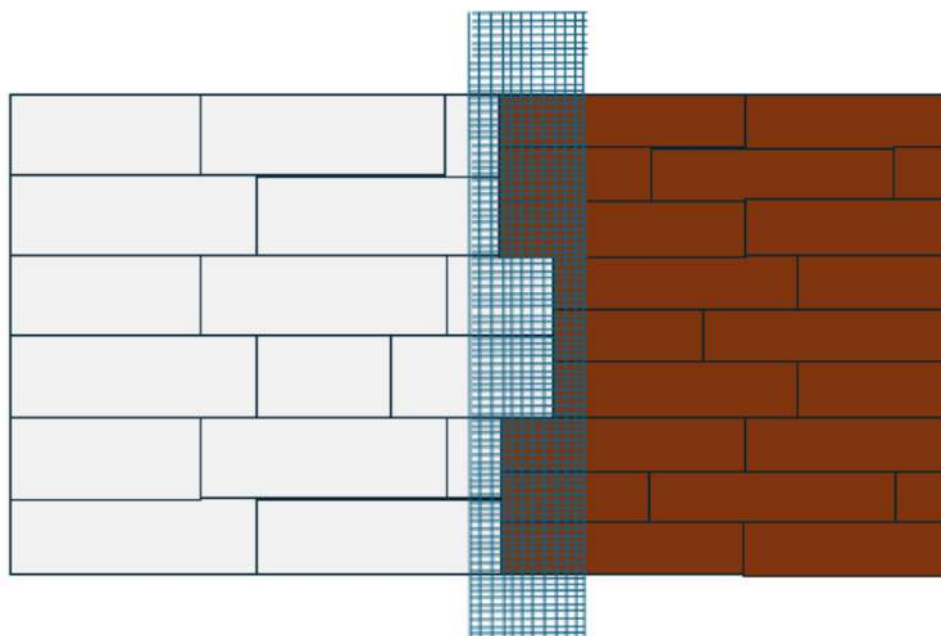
Plan de jonction horizontal-horizontal : Revitherm EP PSE 1,2 m x 0,6 m / Revitherm EP BOIS (isolant STEICO) 1,2 m x 0,4 m
